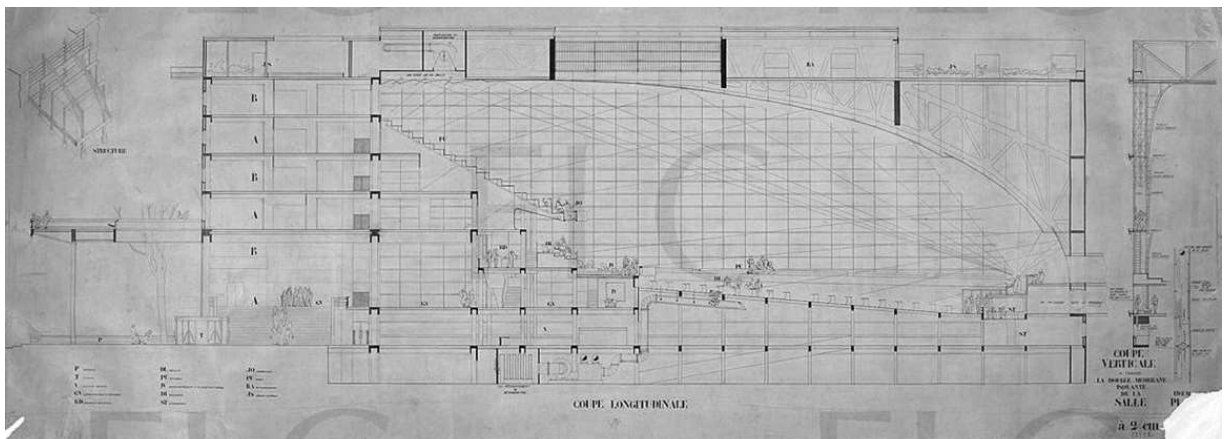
Sección de trazado de conductos para el Edificio Liga de las Naciones. Ginebra 1927.
